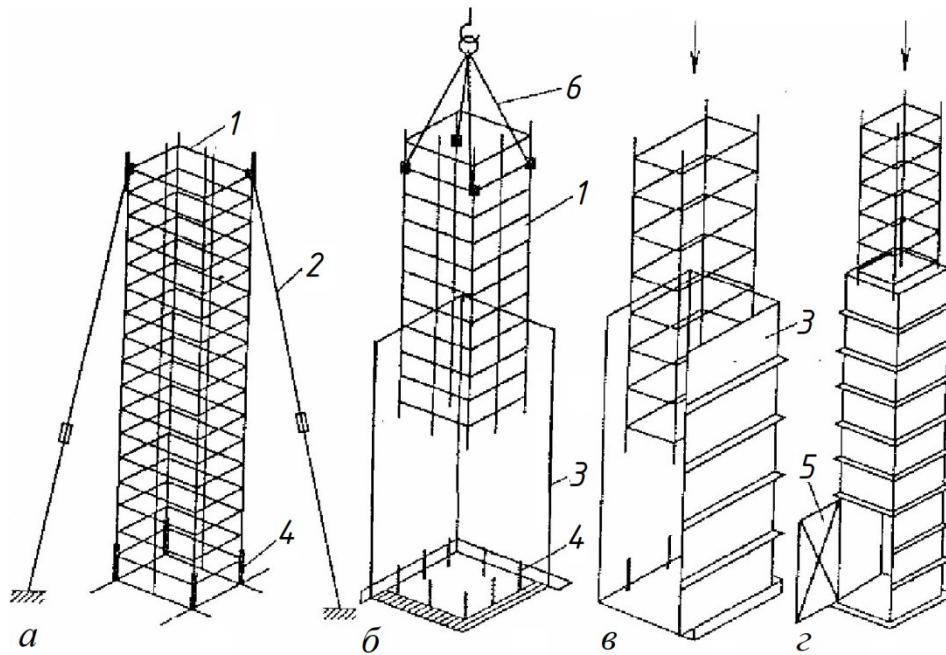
Технологічна схема монтажу арматурних каркасів колон: а - встановлення каркаса в проектне положення з вивіркою розкосами; б - те ж у опалубку з двох щитів; в - те ж у опалубку з трьох щитів; г - при повністю змонтованій опалубці; 1 - арматурний каркас; 2 - розкоси для вивірки й тимчасового кріплення; 3 - щити опалубки; 4 - випуски арматури; 5 - знімний щит для влаштування стиків арматури; 6 - стропувальний пристрій
